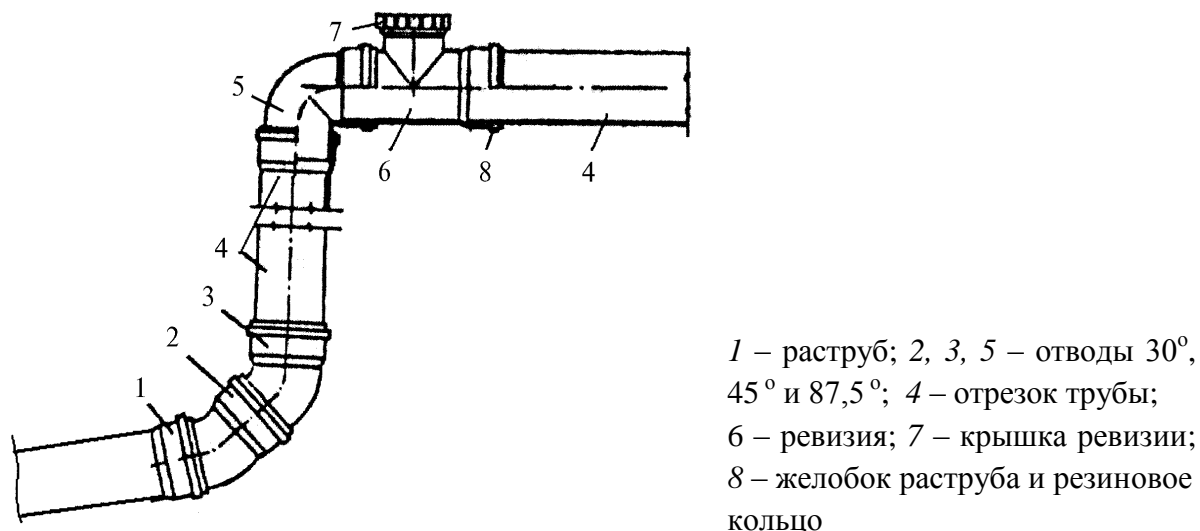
Трубозаготовка, выполненная из труб и соединительных частей из НПВХ с раструбными соединениями на резиновых кольцах
